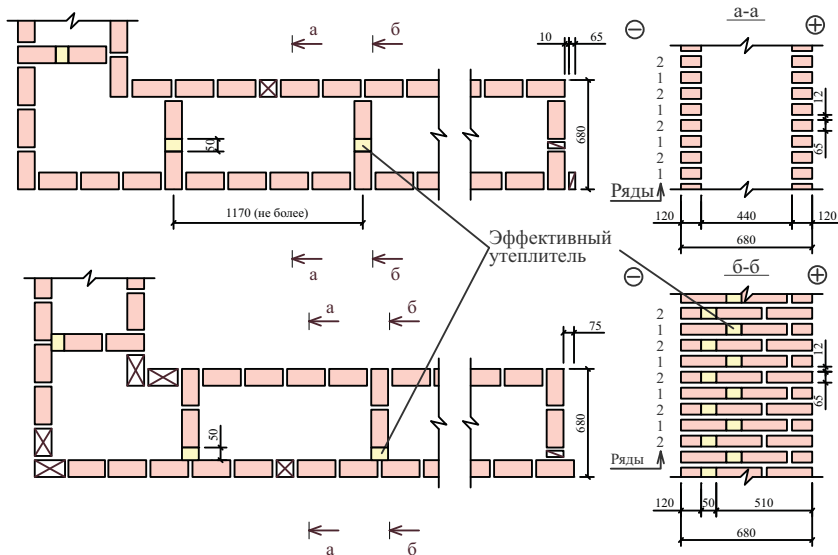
Наружная стена из кирпичной кладки с вертикальными кирпичными диафрагмами с самонесущим внутренним слоем (тип КД-1), толщиной 68 см. Сечение 18-18
